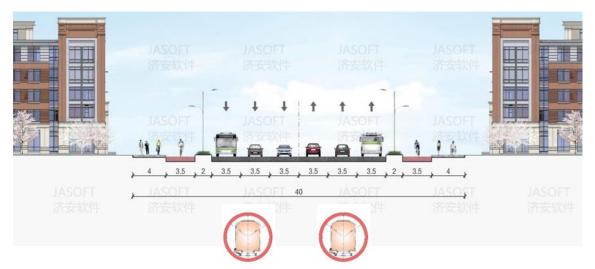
线路沿虹桥路 (40m) 路敷设横断面示意图
